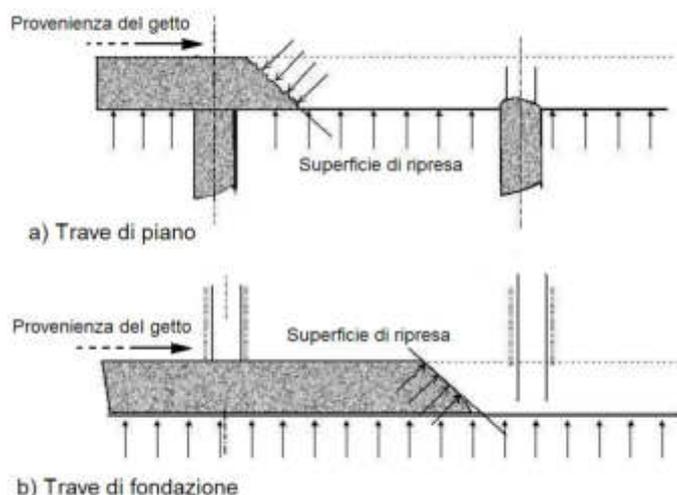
Modalità di ripresa del getto in travi di piano e di fondazione
